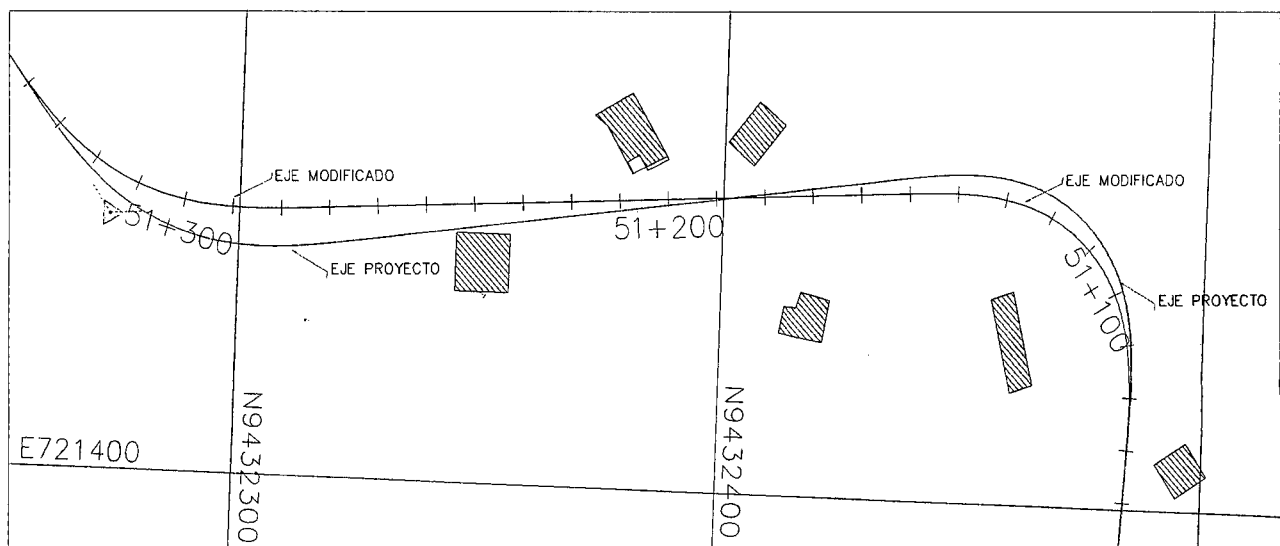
Plano en planta de la comparación del eje del proyecto y el replanteado de la variante 04.
